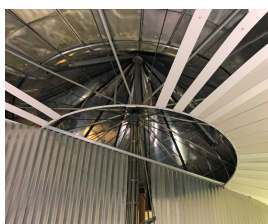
Estrutura reparada e restaurada, vista do interior da casa.
